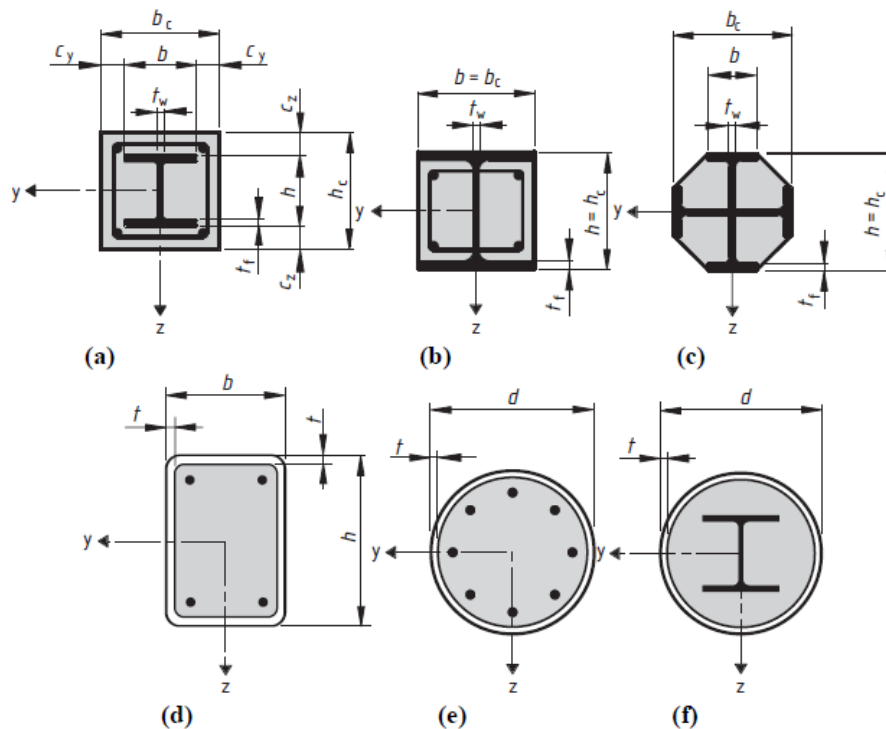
Secciones transversales compuestas típicas (Eurocódigo 4).
